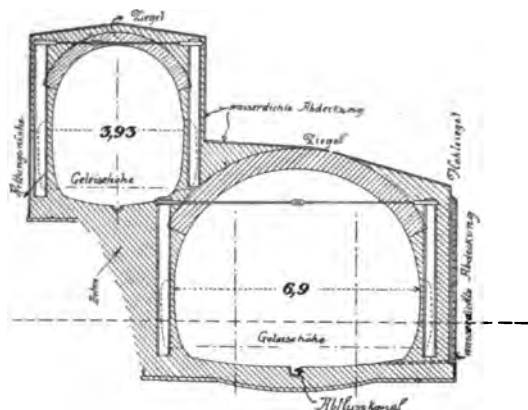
Querschnitt des Typs in der Bausektion 4 der Bostoner Untergrundbahn.
